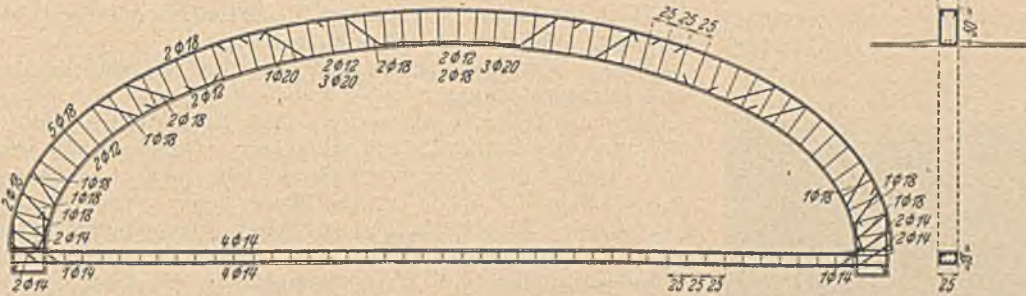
Der Eisenbeton-Binder der Dachhaut (über Nepos-Decke).
